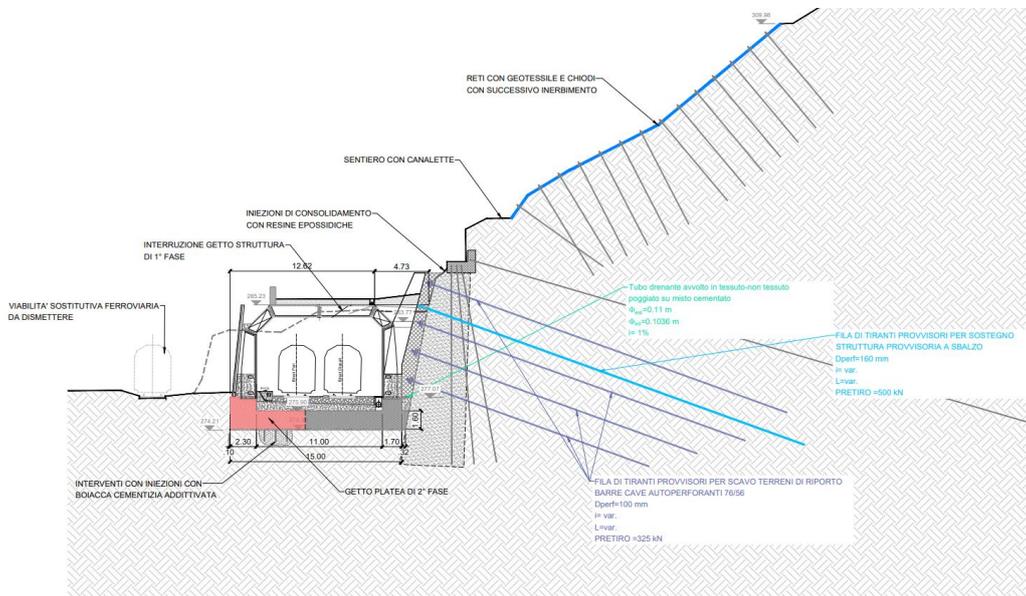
Stralcio di una sezione di intervento sul muro da consolidare lato Ovada.
